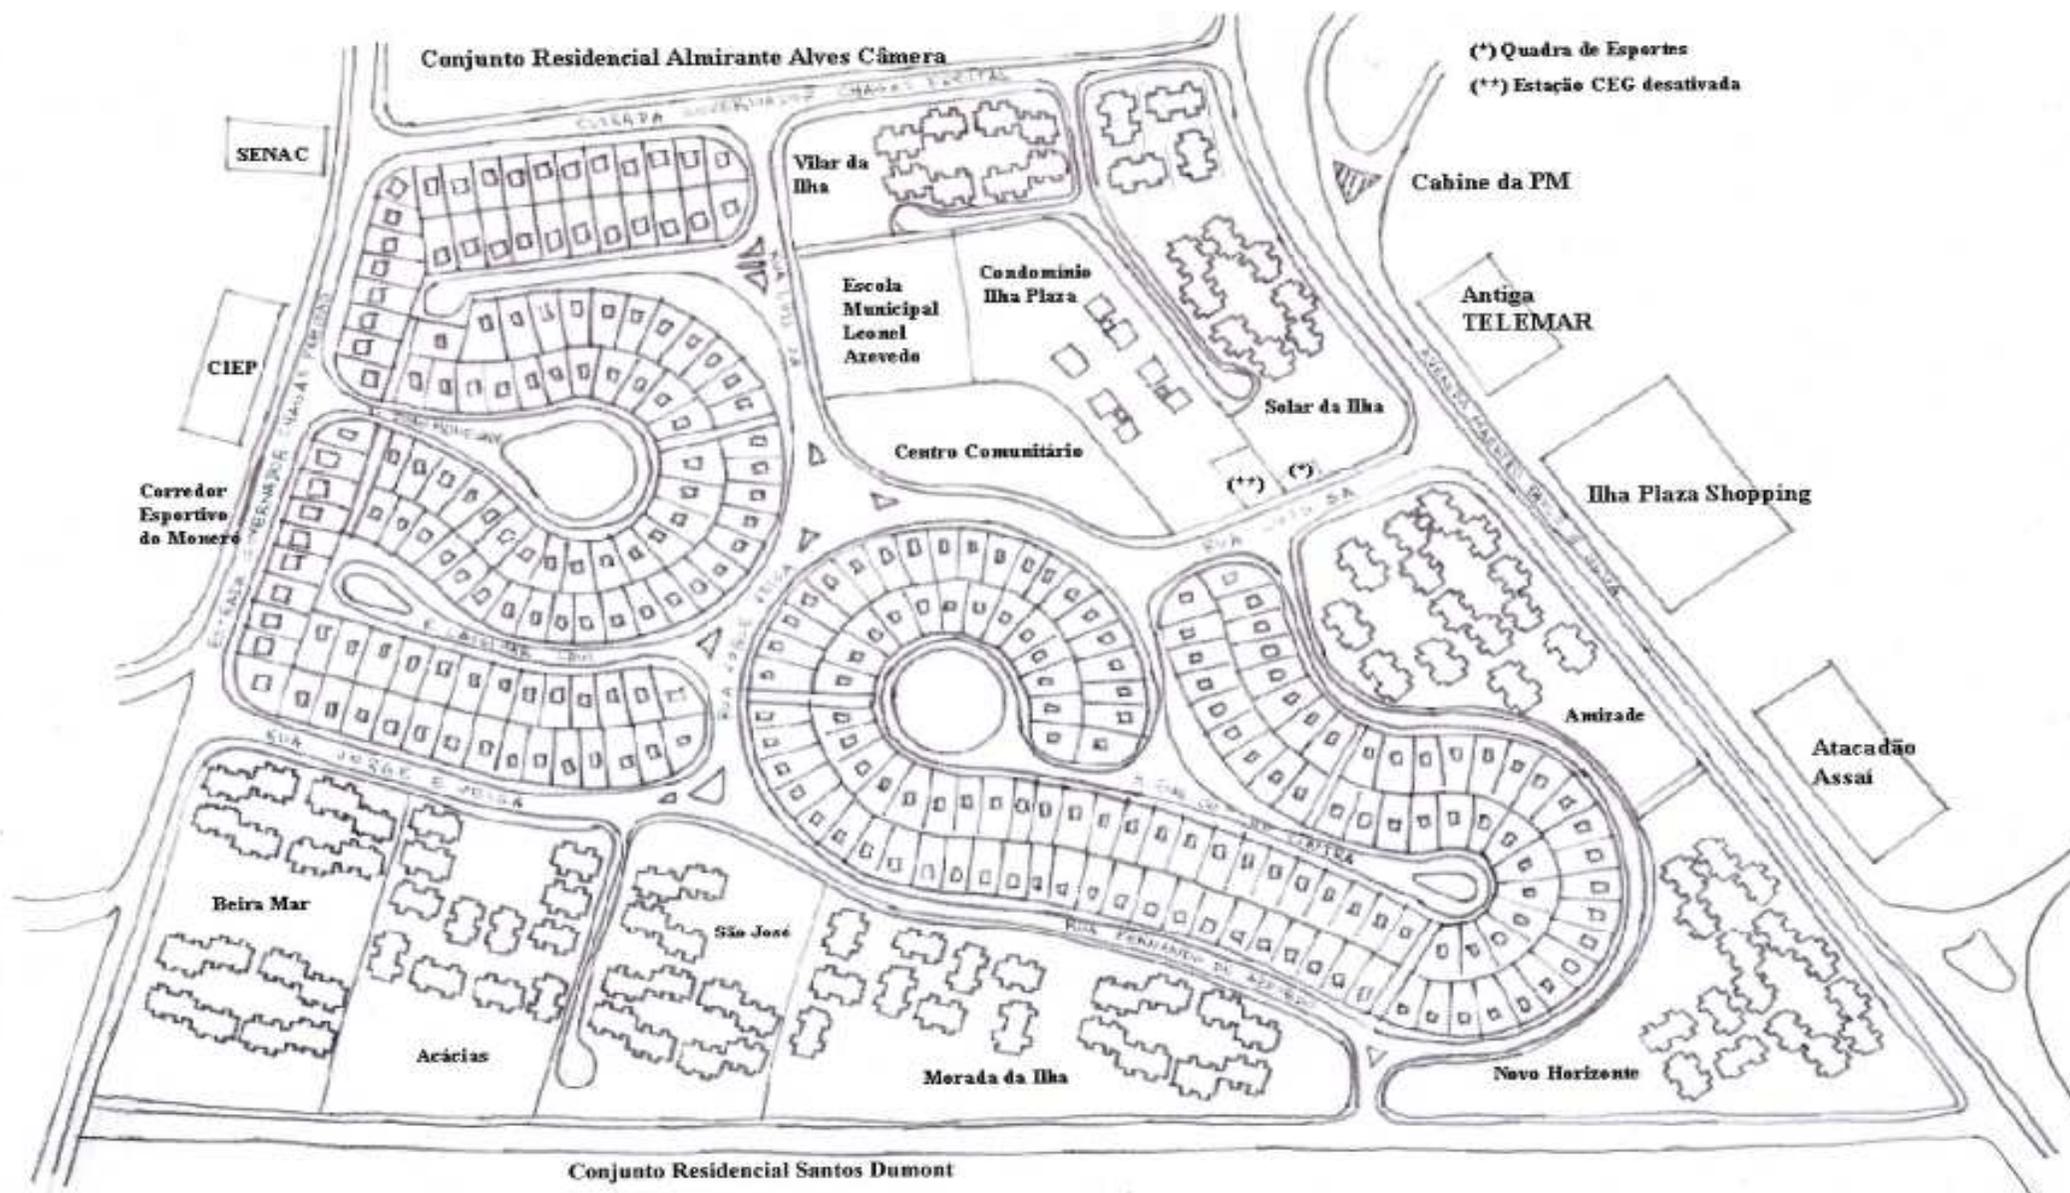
Planta de situação do Conjunto Residencial Village da Ilha
